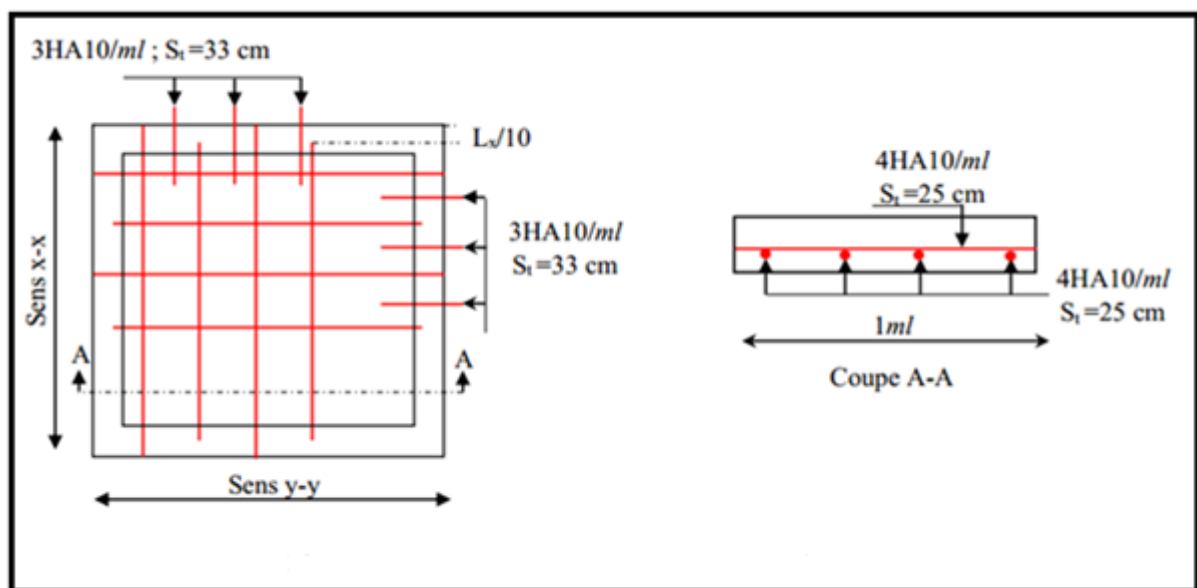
Schéma de ferrailage de la dalle d'ascenseur
